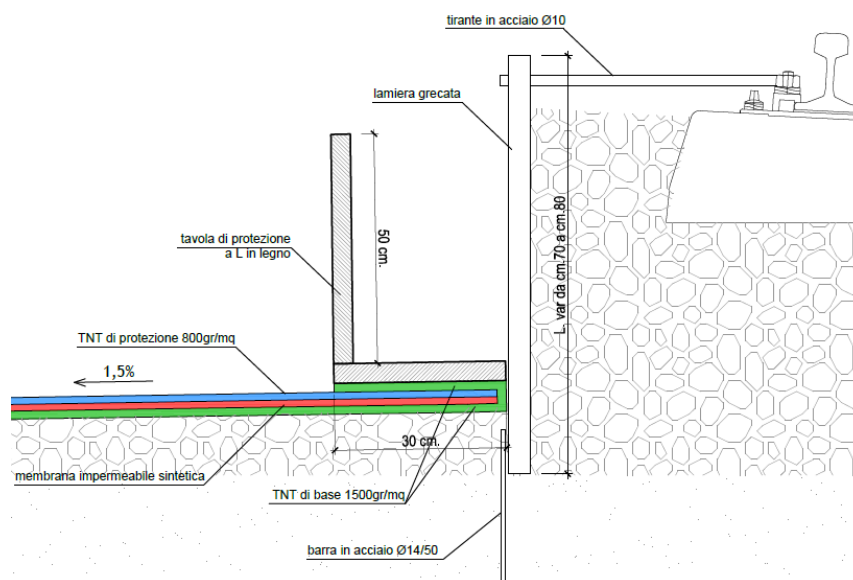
b - Protezione della giunzione longitudinale
